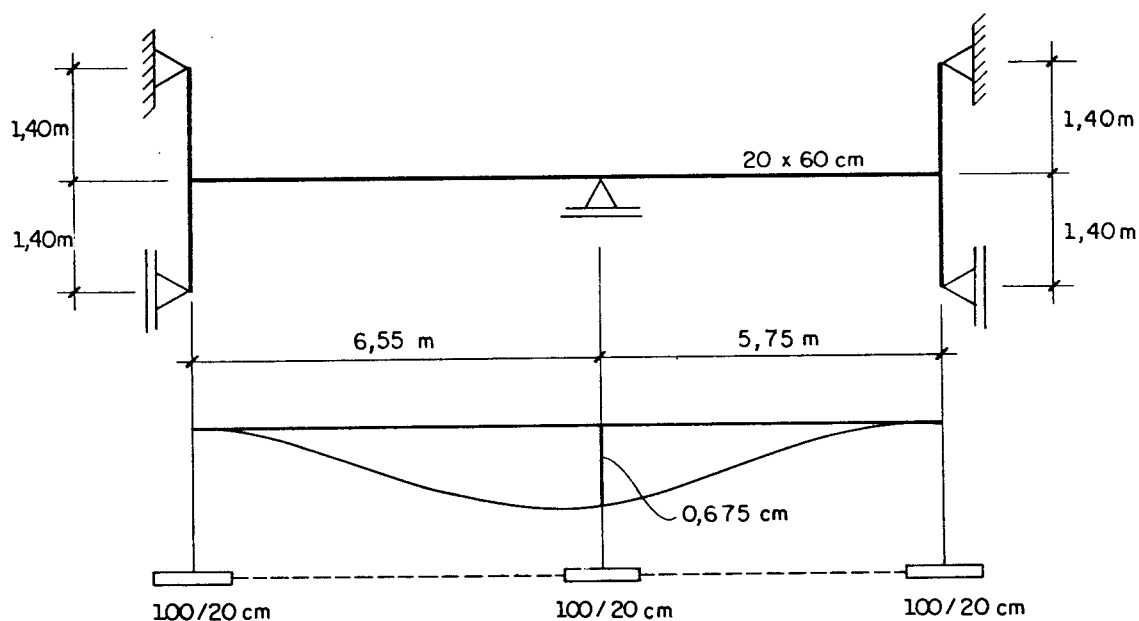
Pórtico simplificado da viga VT09 submetido ao recalque de apoio intermediário indicado pelo modelo de pórtico plano
